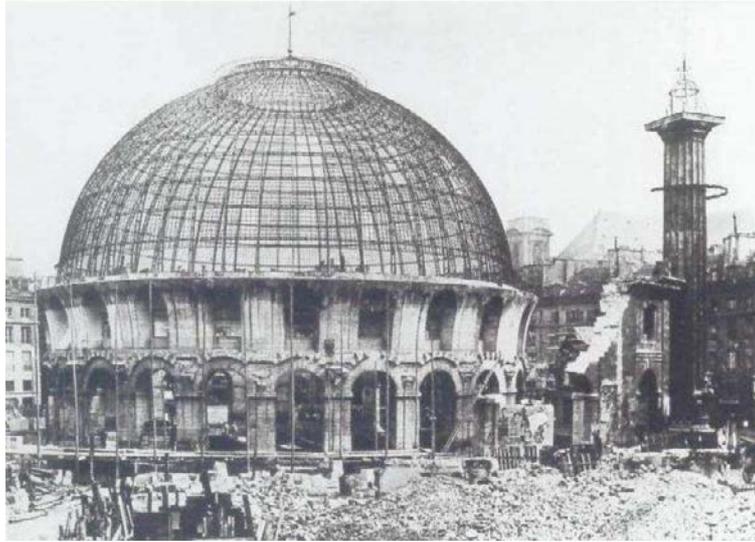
Reconstrucción de la cúpula de la Halle au Blé, 1811; fuente: arquitecturaenacero.org
